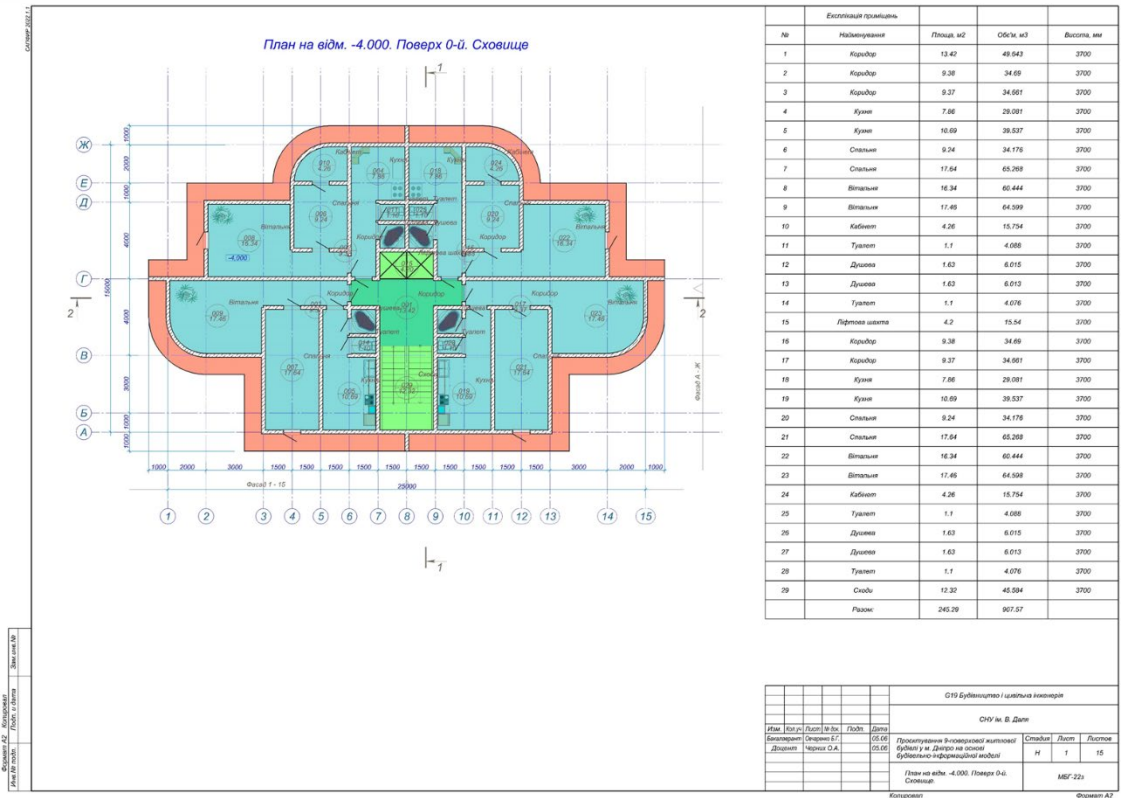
План на відм. -4.000. Поверх 0-й. Сховище
